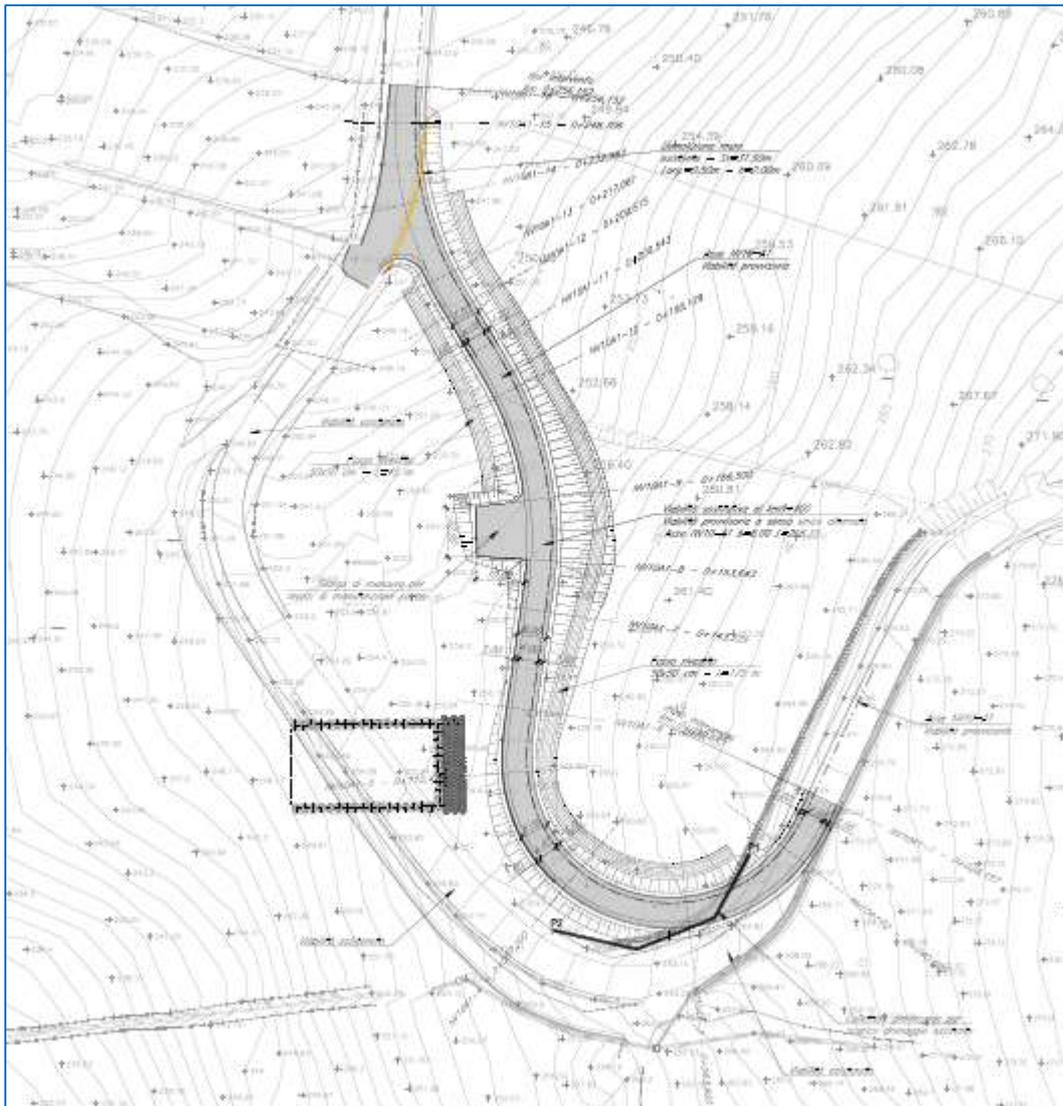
Planimetria Viabilità Sostituiva NV10
